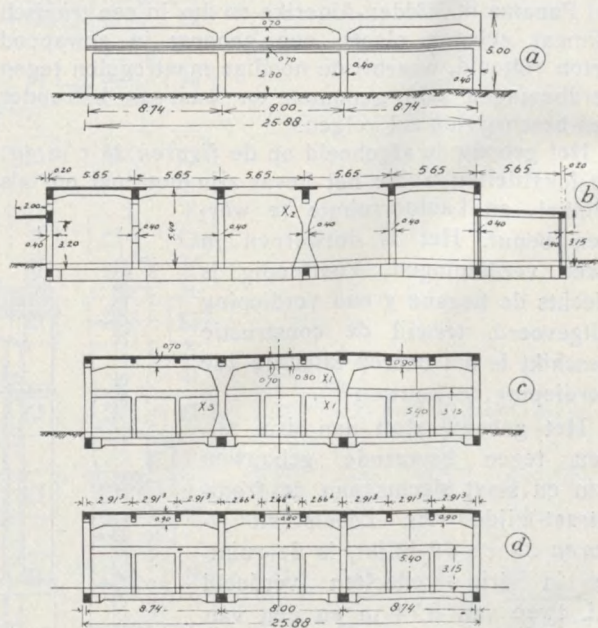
Gewapend beton winkelgebouw te San José, Costa Rica (1:500).
